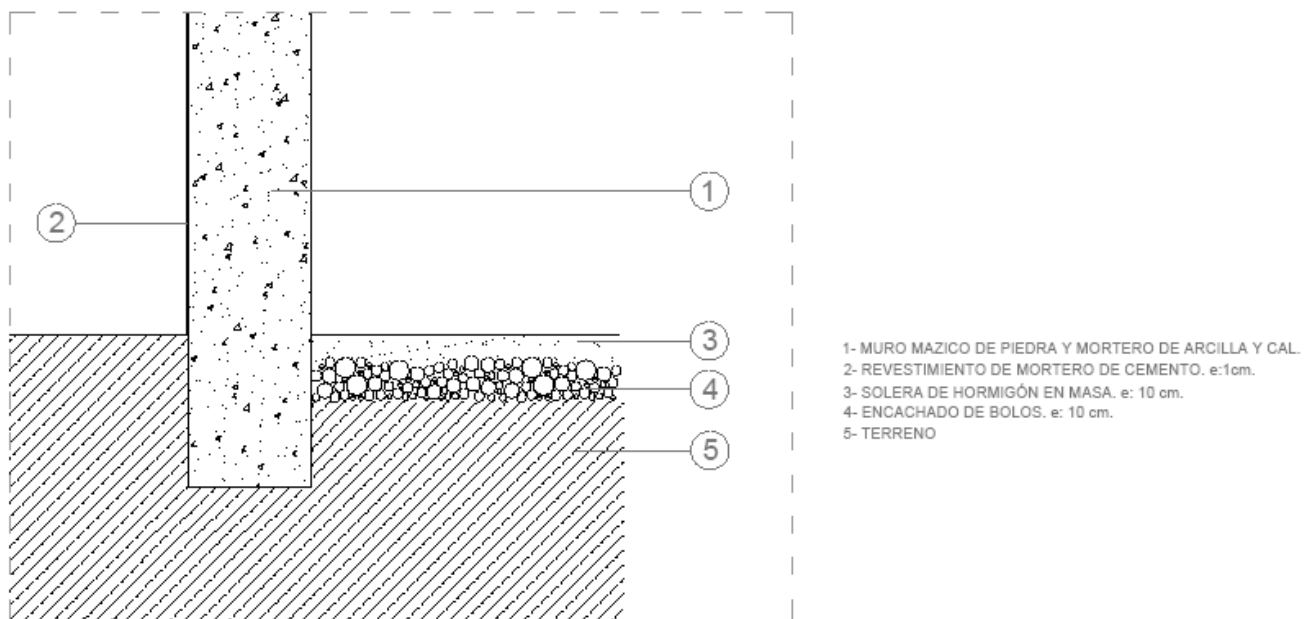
Detalle cimentación. Fuente: Propia autora
